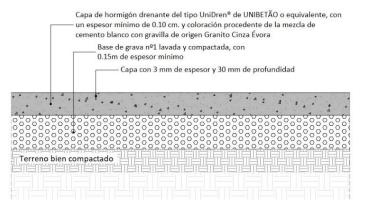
Detalle constructivo del pavimento de hormigón poroso. Fuente: Proyecto básico y de ejecución EB1 de Horta das Figueiras
